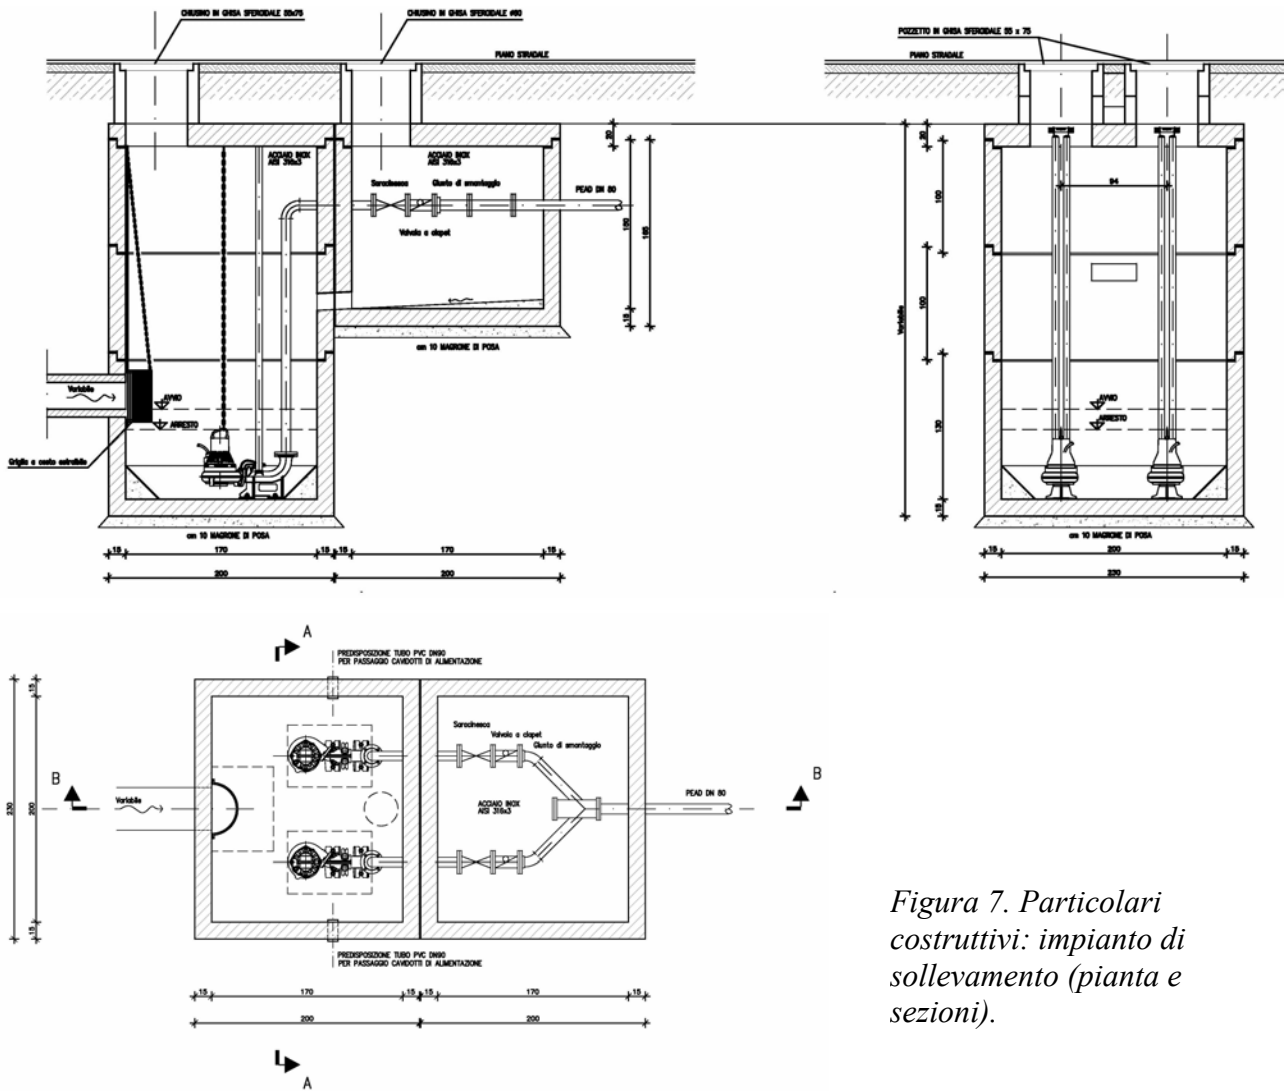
Particolari costruttivi: impianto di sollevamento (pianta e sezioni).
